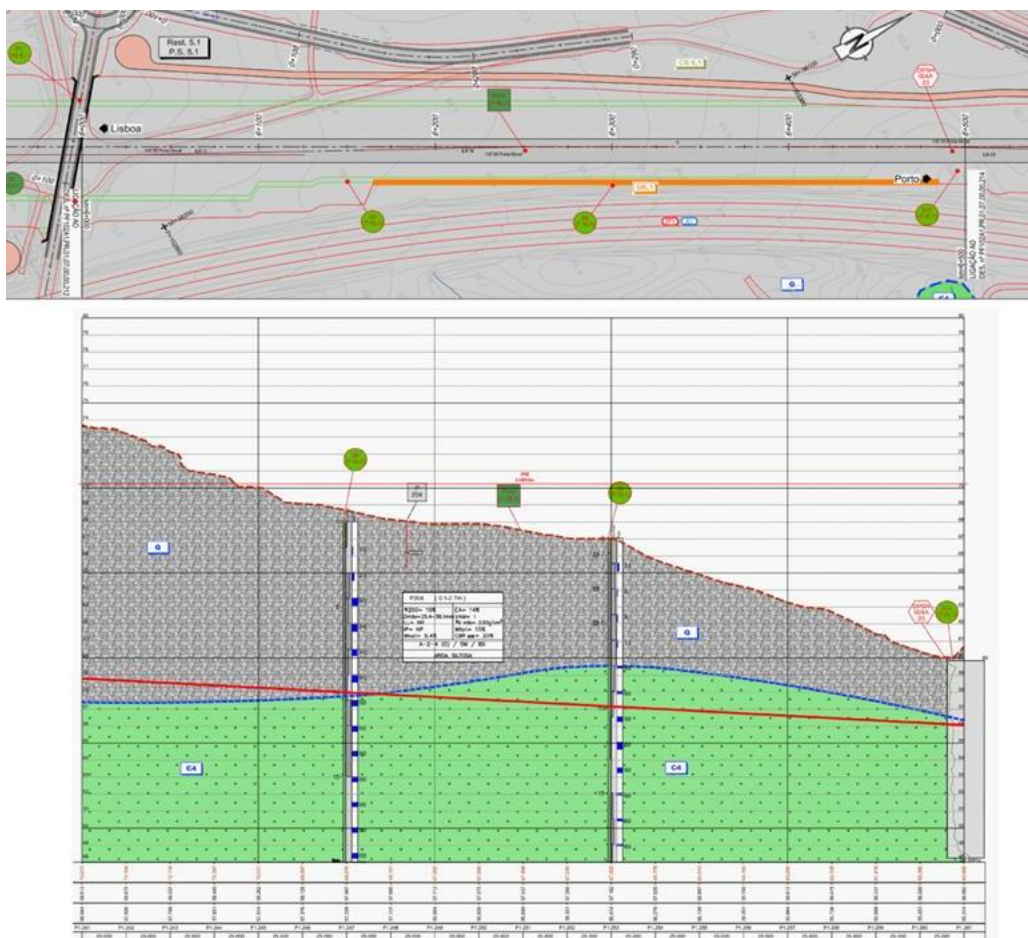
Muro M6.1. Planta e corte geotécnico. Extrato do Des. PF102A1.PR.01.07.00.00.113.00
